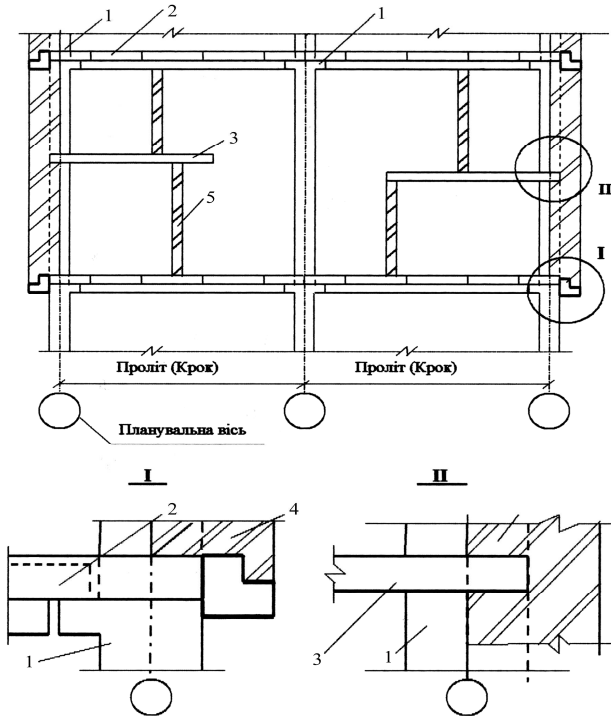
Модифікація каркасної системи на базі с.1.020-1/87 з несуче-навісними дрібноштучними стінами: варіанти компонування квартир у двох поверхах, поперечний розріз будівлі (фрагмент):
